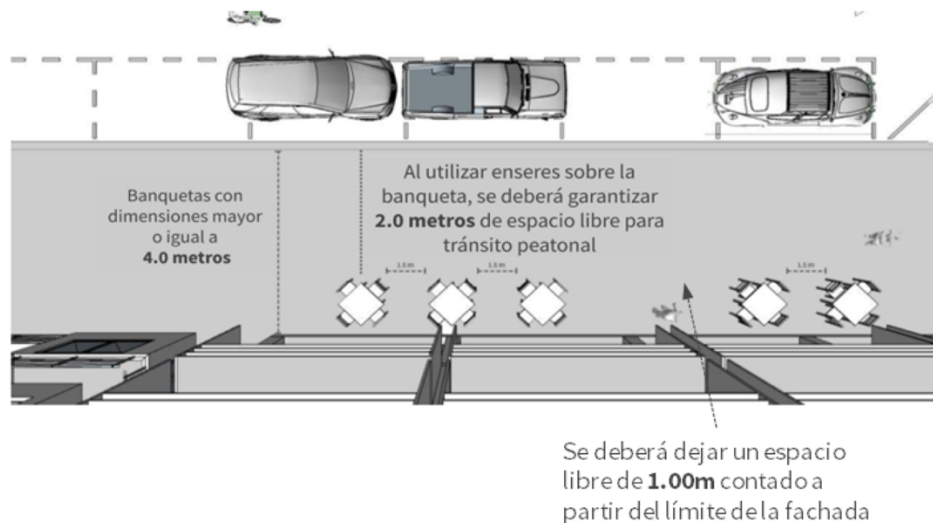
Colocación de enseres en banquetas con un ancho igual o mayor a 4.0 metros
